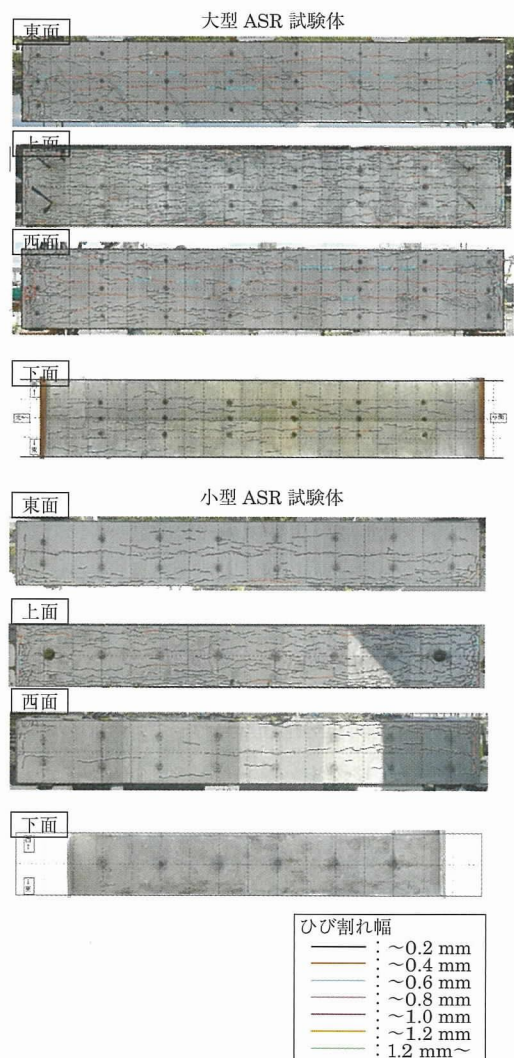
材齢 240 日計測におけるひび割れ図
